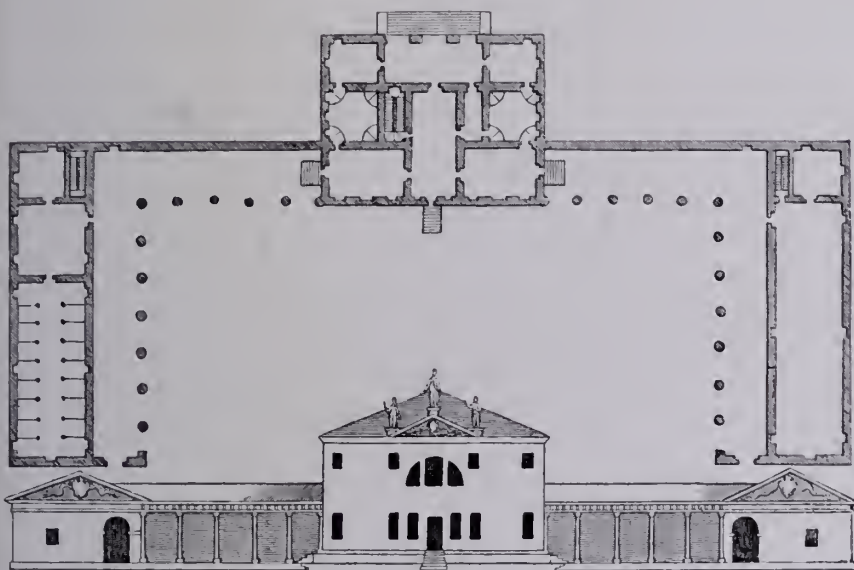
Cesalto nel Trevigiano, Villa Zen. Palladio: Pianta e prospetto.
